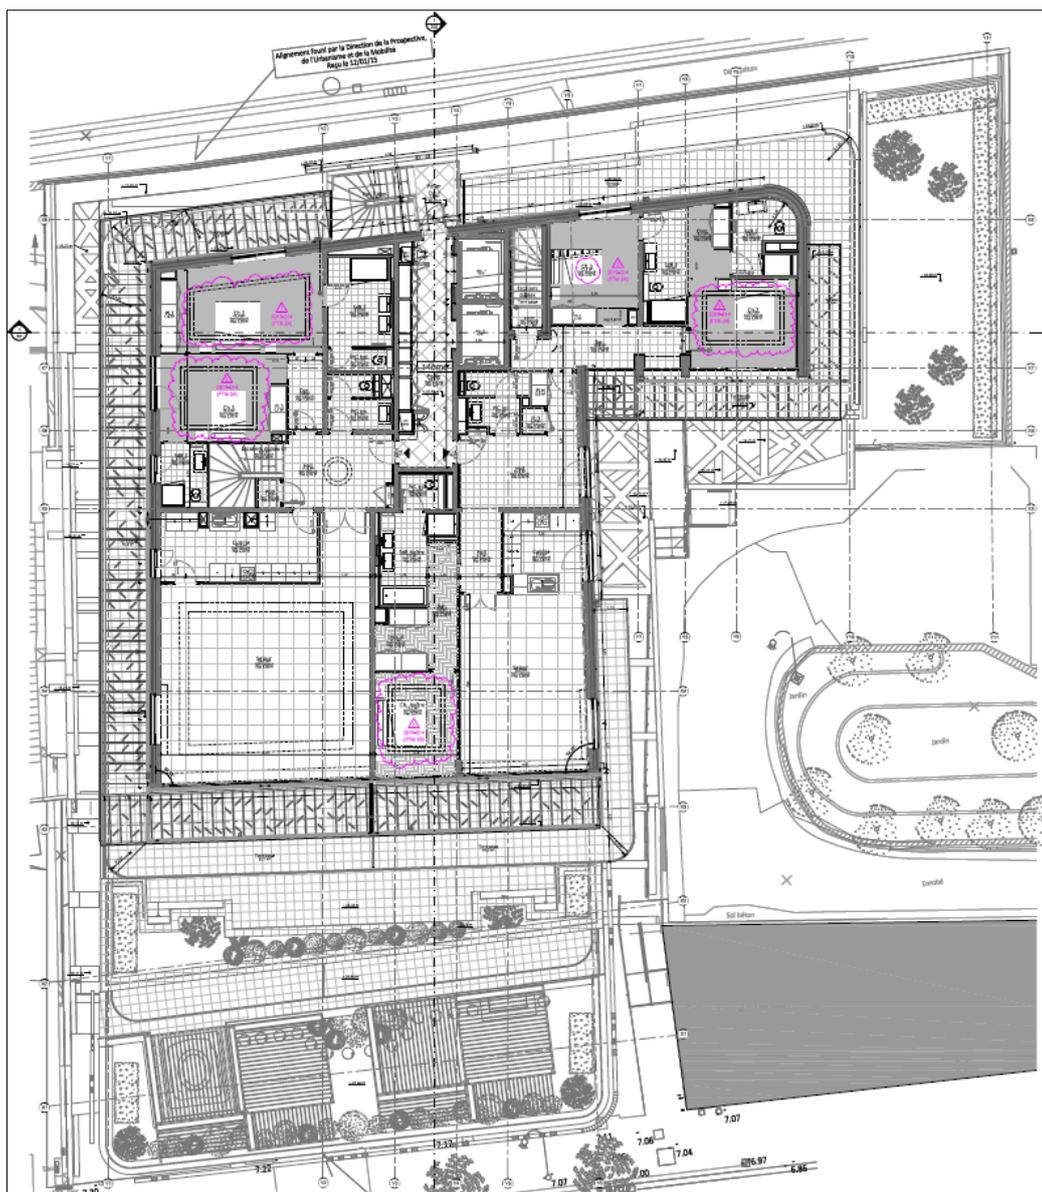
Pianta architettonica, quattordicesimo piano (R+14 duplex)
